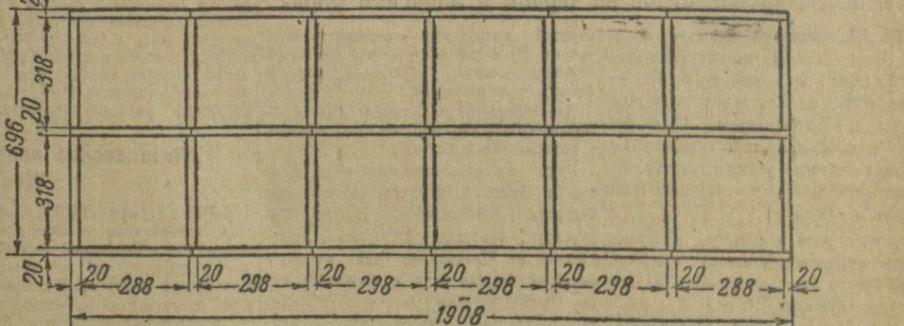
Двухрядная двенадцатисекционная силосная траншея из железобетонных плит. 1 — наружная стенка; 2 — внутренняя стенка; 3 — днище; 4 — мягкая глина; 5 — грунт; 6 — одерновка; 7 — кровля. Емкость каждой секции 29,4 кубометра.
